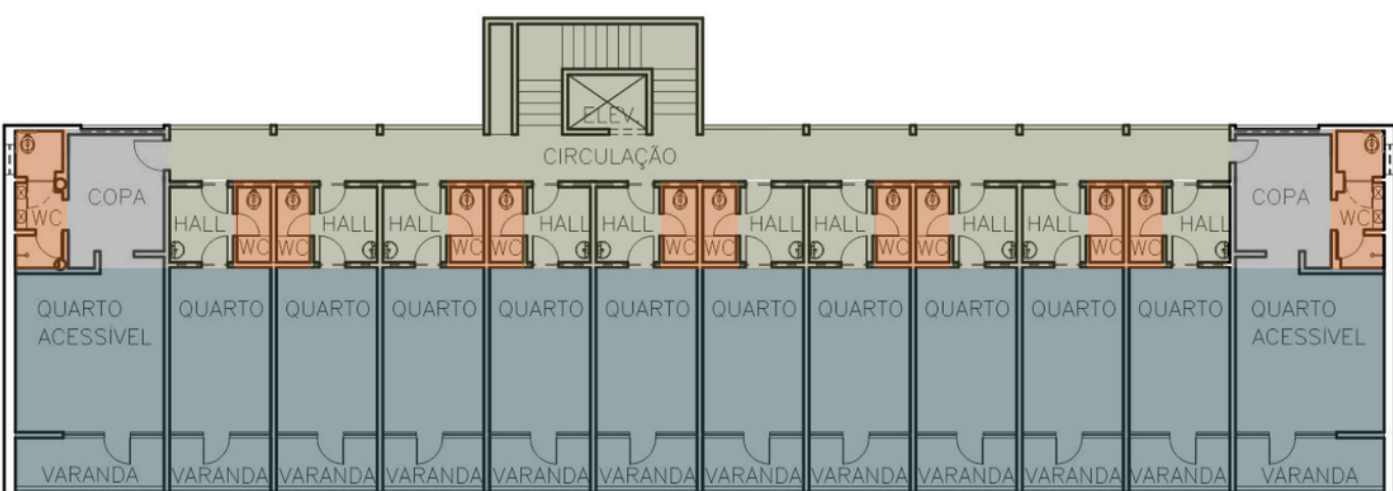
Planta baixa do 1º pavimento da Residência Universitária do Campus do Benfica.
